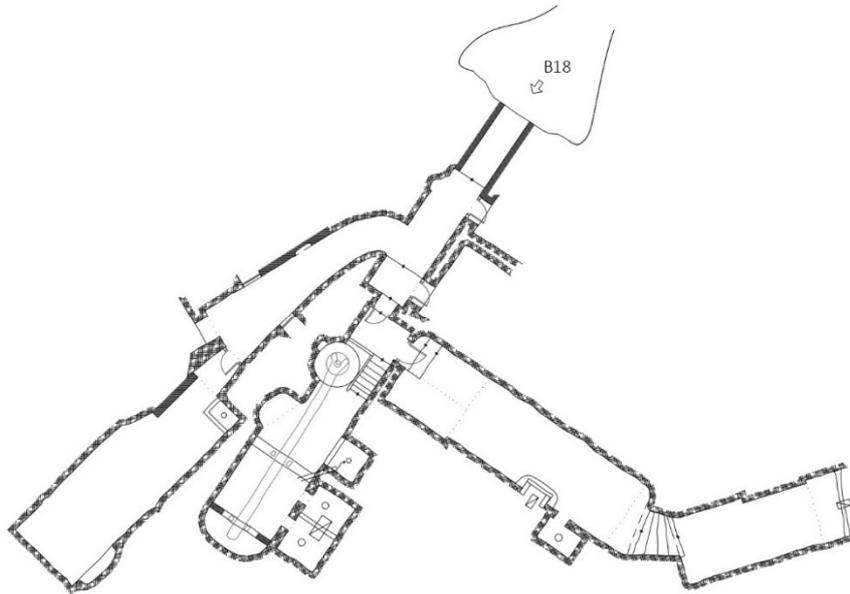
Planta bodega SRH_B18. Escala: 1/400. Fuente: *Elaboración del autor.
